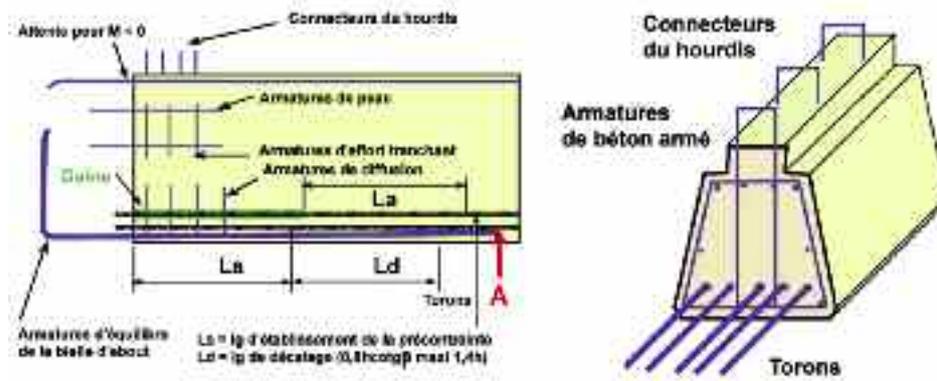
dispositions constructives (ferraillage et câblage) des extrémités des poutres de type PRAD
